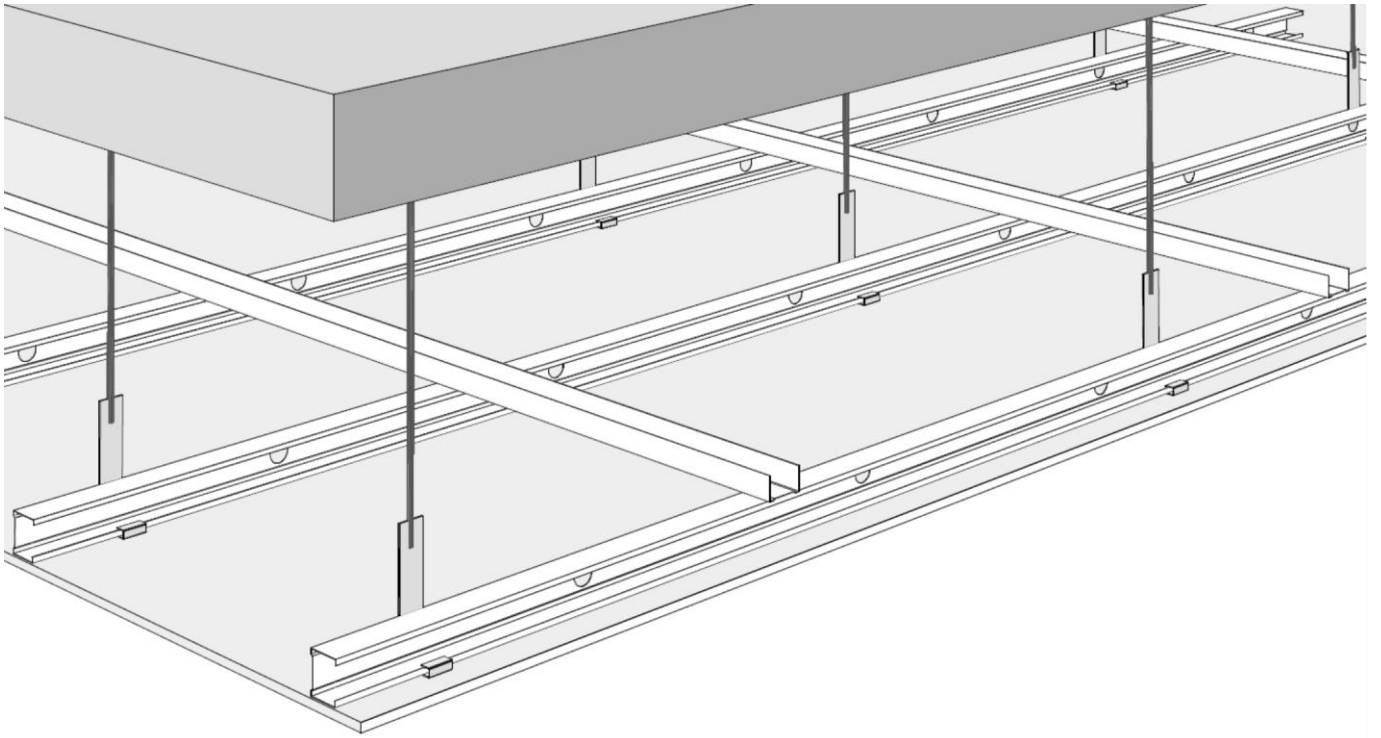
mise en œuvre entretoise « anti-dévers » (rail) pour les plafonds sur montants simples
